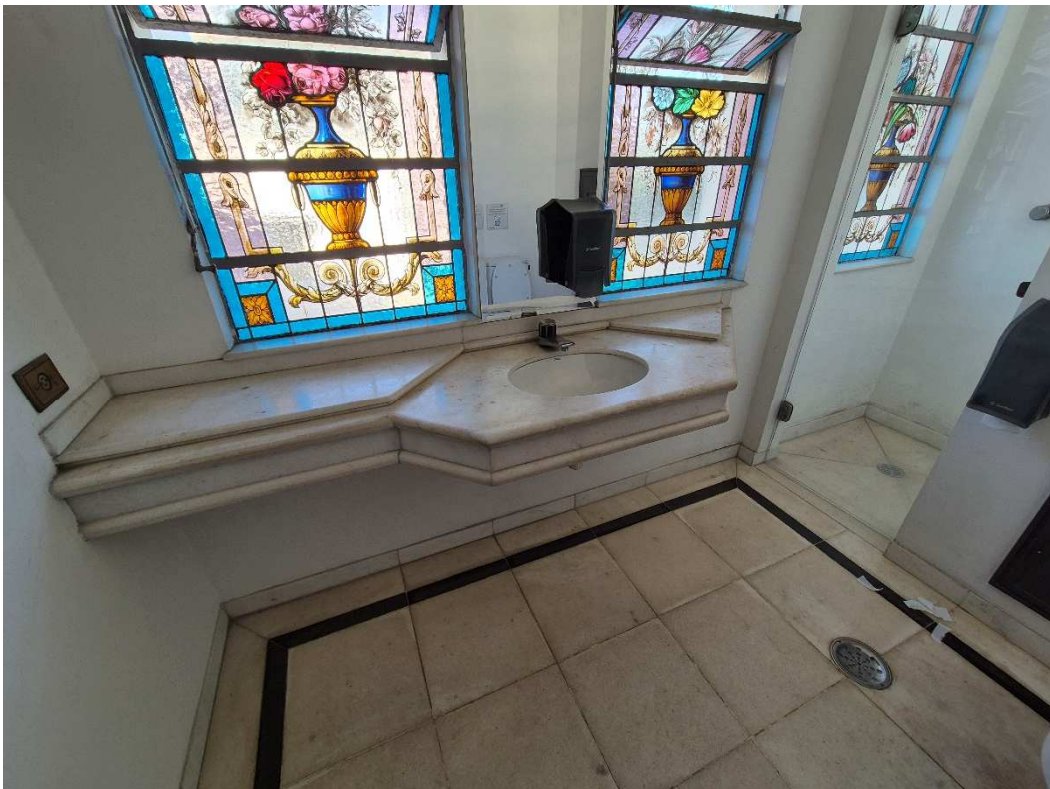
Aspecto interno da edificação principal (Pavimento Superior).
